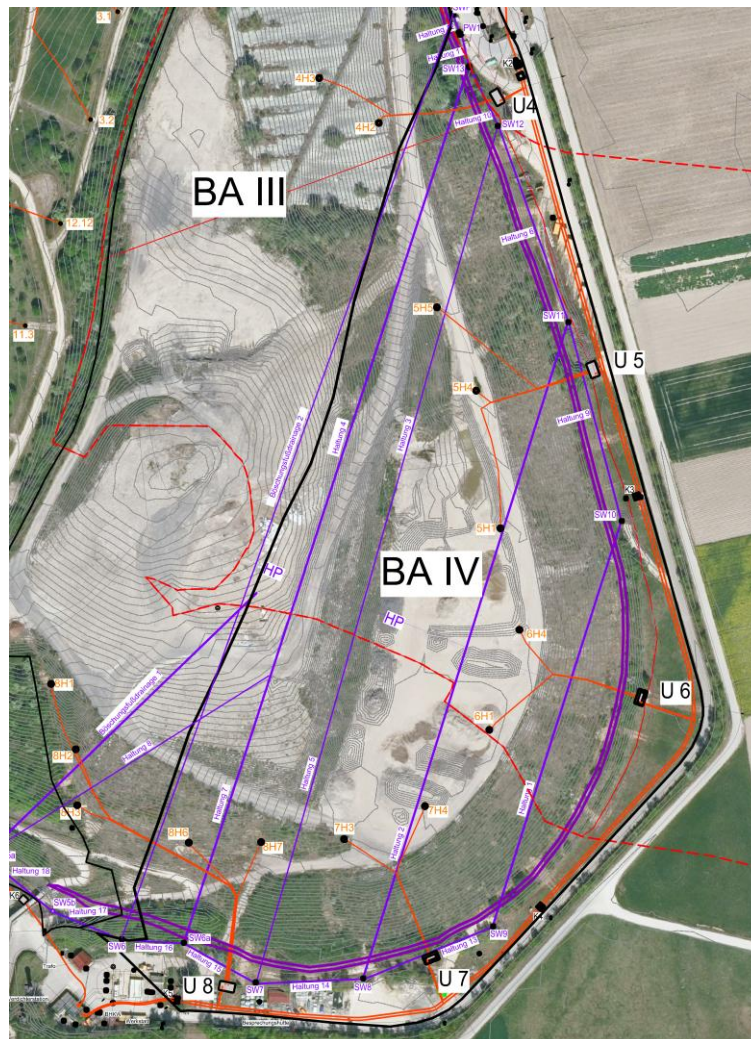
Lageplan der Sickerwasserleitungen Bestand BAIII/BAIV (Anlage 1.2.3)
